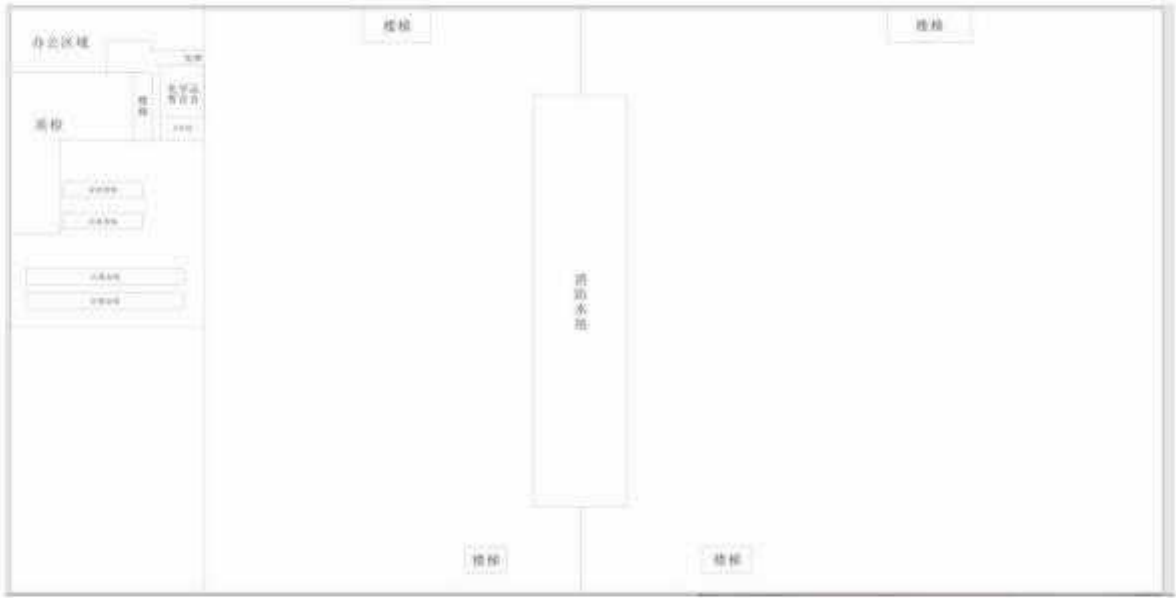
项目厂房 2.3.4 五层平面布置图
